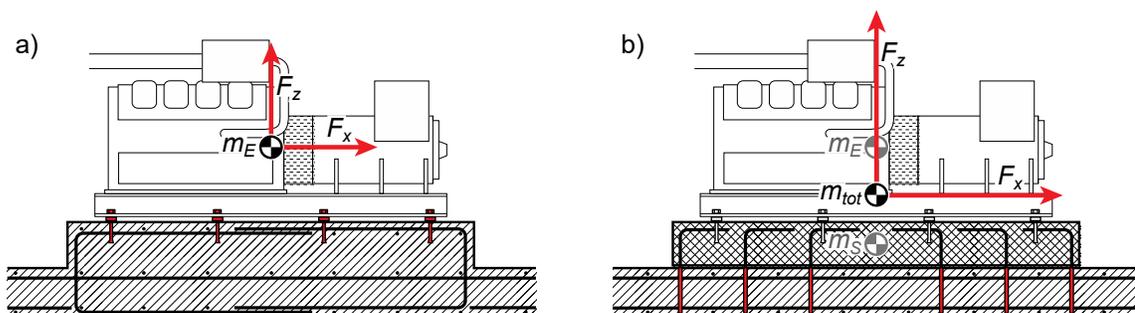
Für den Nachweis massgebende Schockeinwirkung bei einem a) monolithisch verbundenen und einem b) nachträglich betonierten Betonsockeln
